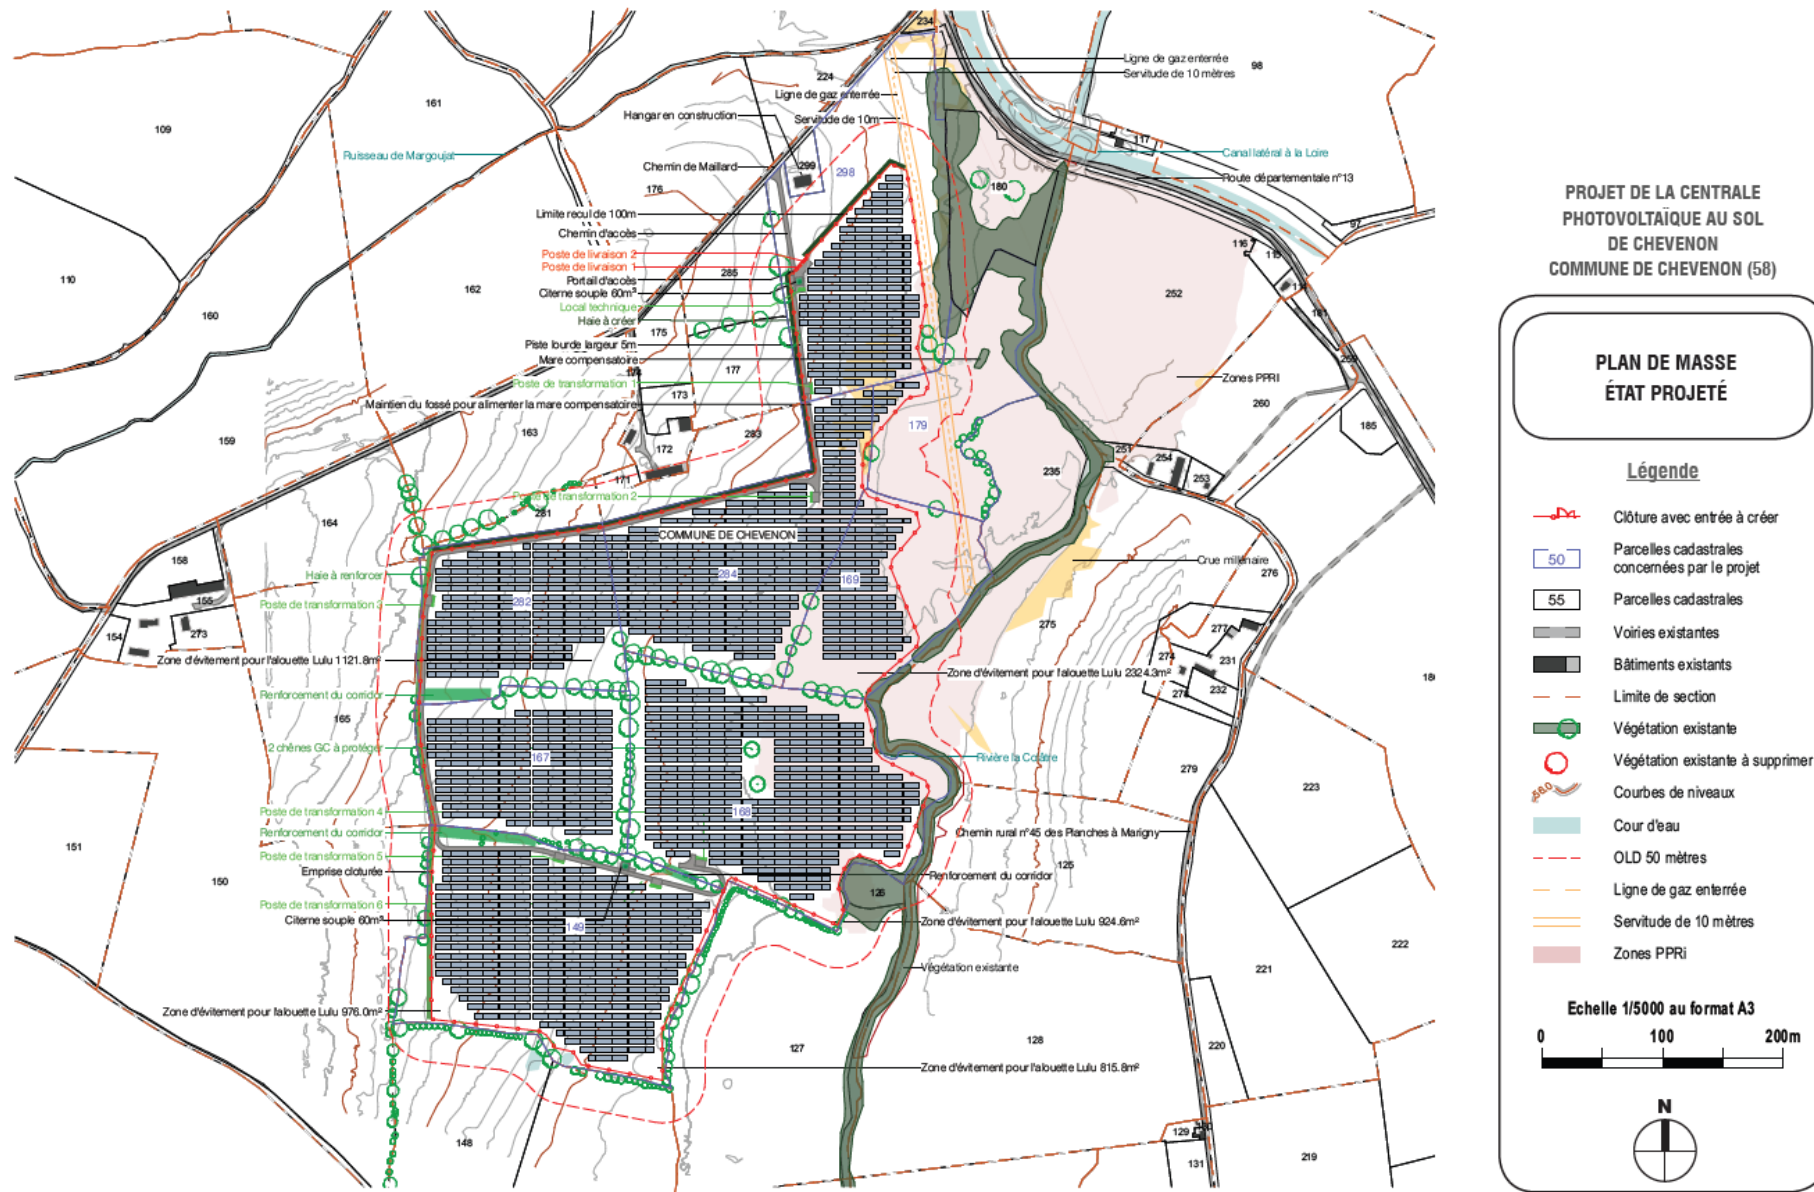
Plan masse du projet (source : PHOTOSOL)
